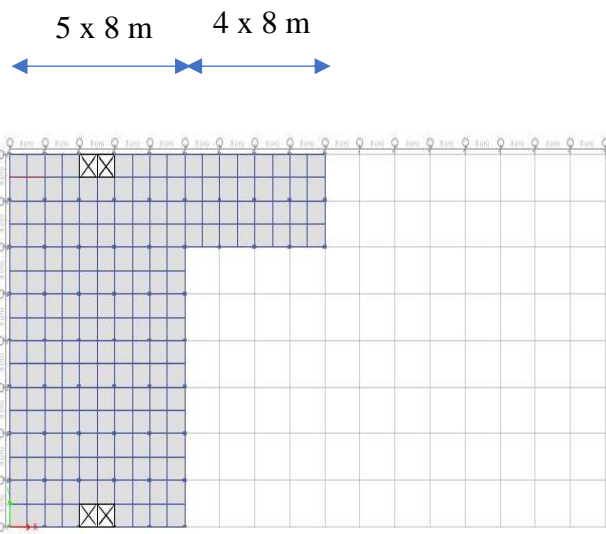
Denah Lantai 1 - Lantai 2 Model B1
